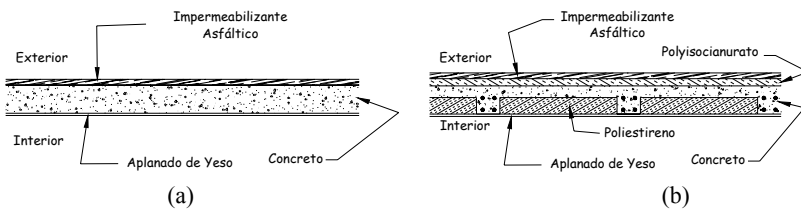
Sección Transversal de Losas de Techo, (a) Sólida, (b) Aligerada y Aislada
